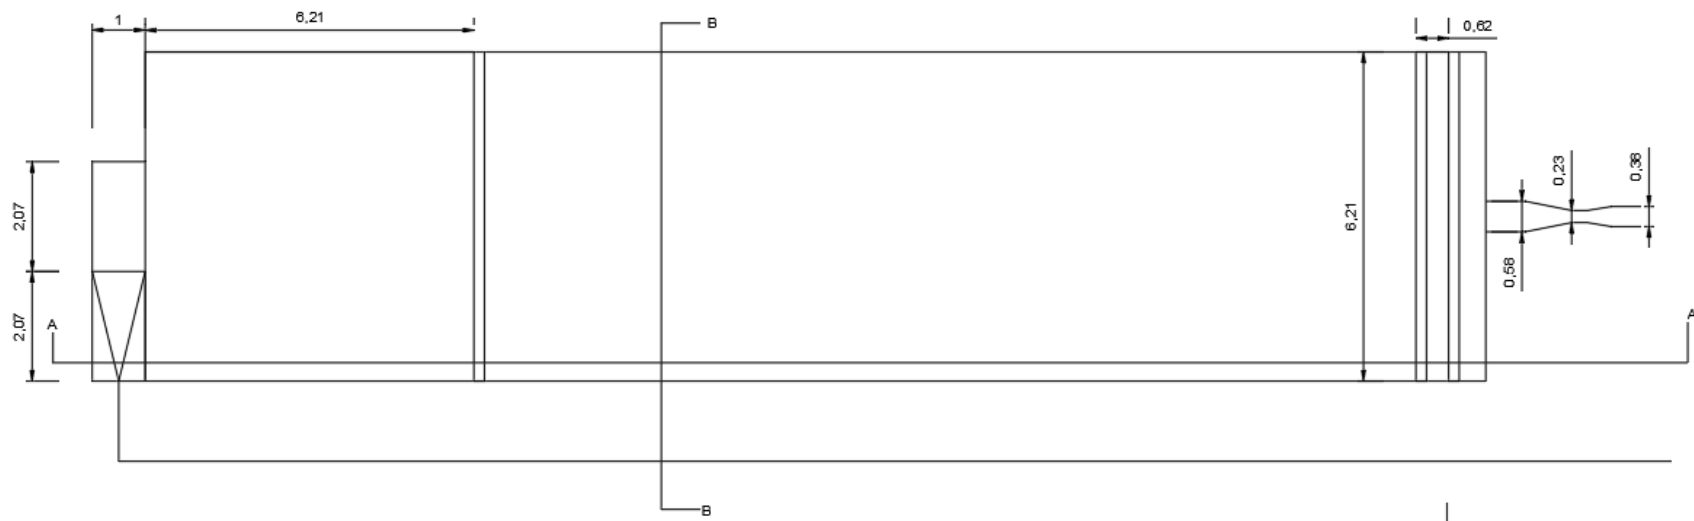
Vista en planta de las estructuras hidráulicas, tomada de software AutoCAD.
